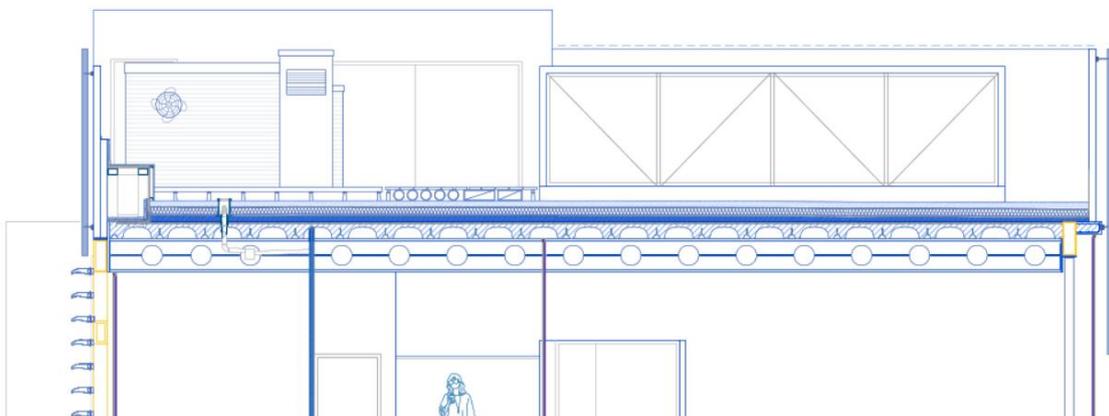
DETALLE CUBIERTA DEL PROYECTO
